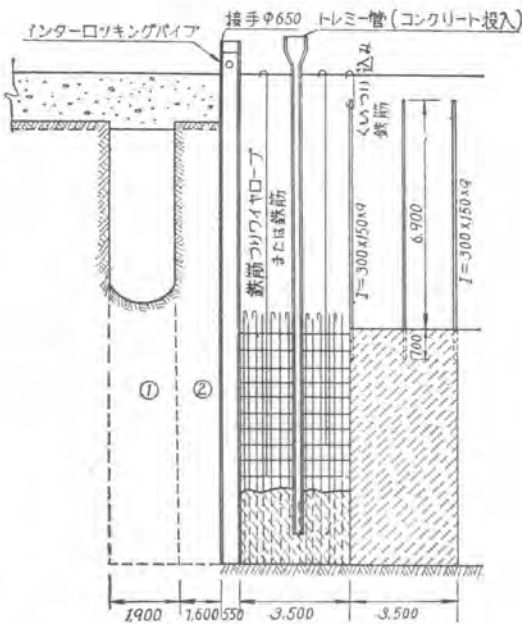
掘削、鉄筋かごつり込コンクリート打設順序図 (縦断面)
